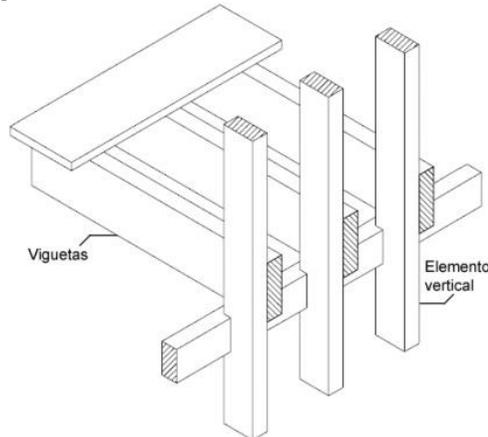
Viguetas de forjado clavadas al elemento vertical ⁶
